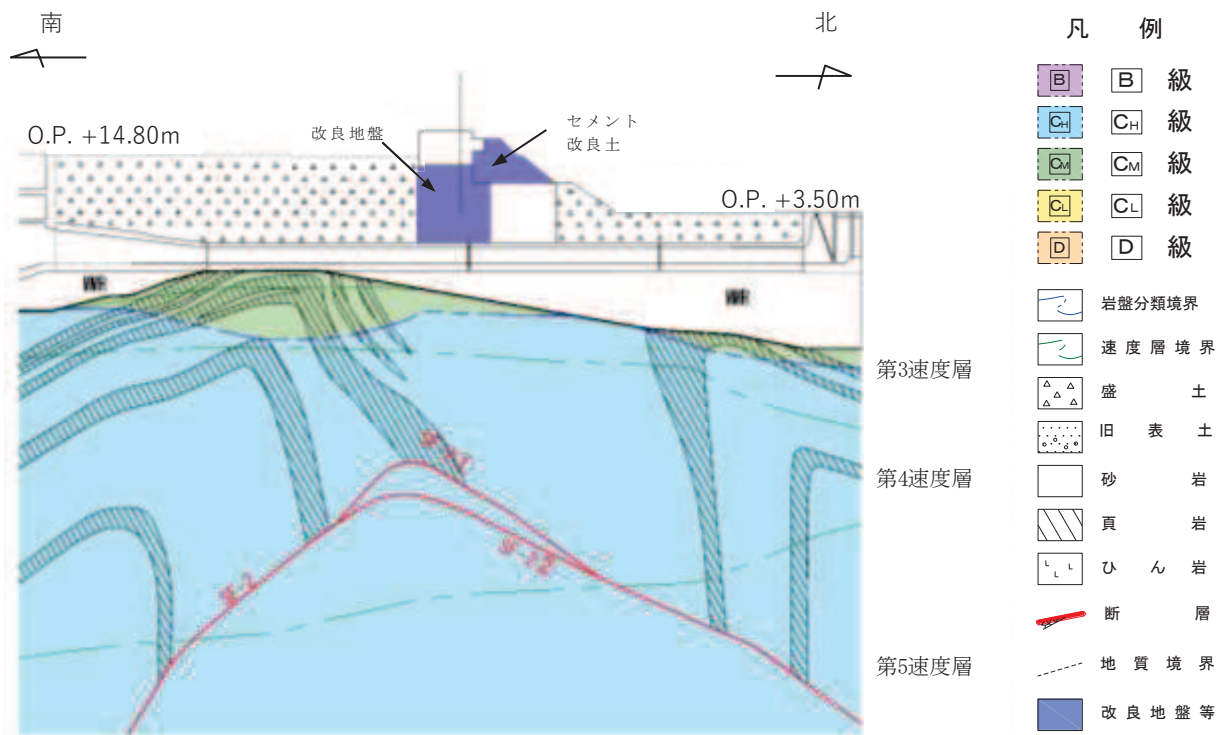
(1) 取水路の地質断面図 (⑲-⑲断面)
